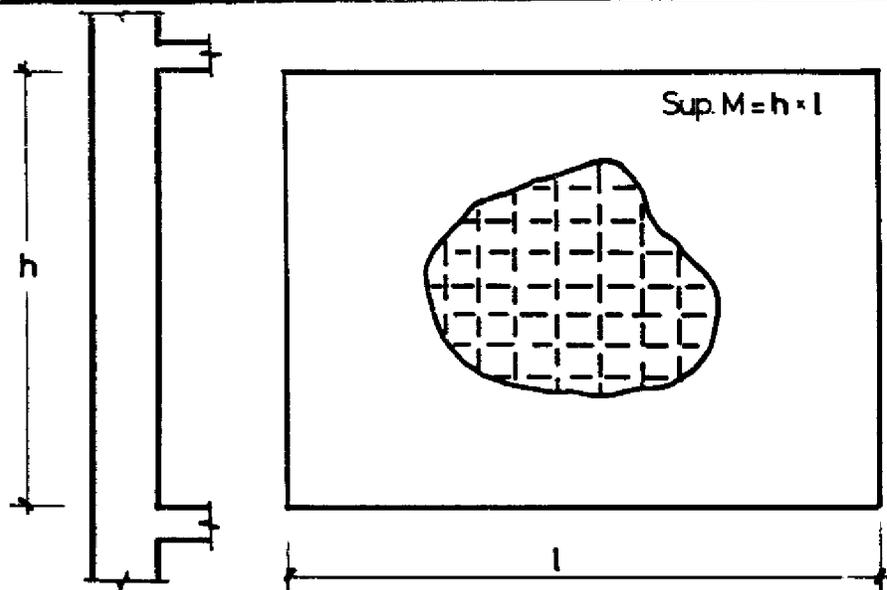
Caso M-1. REPARACIONES DE FALLAS DE HORMIGONADO EN MUROS DE HORMIGON ARMADO (nido de piedras)
